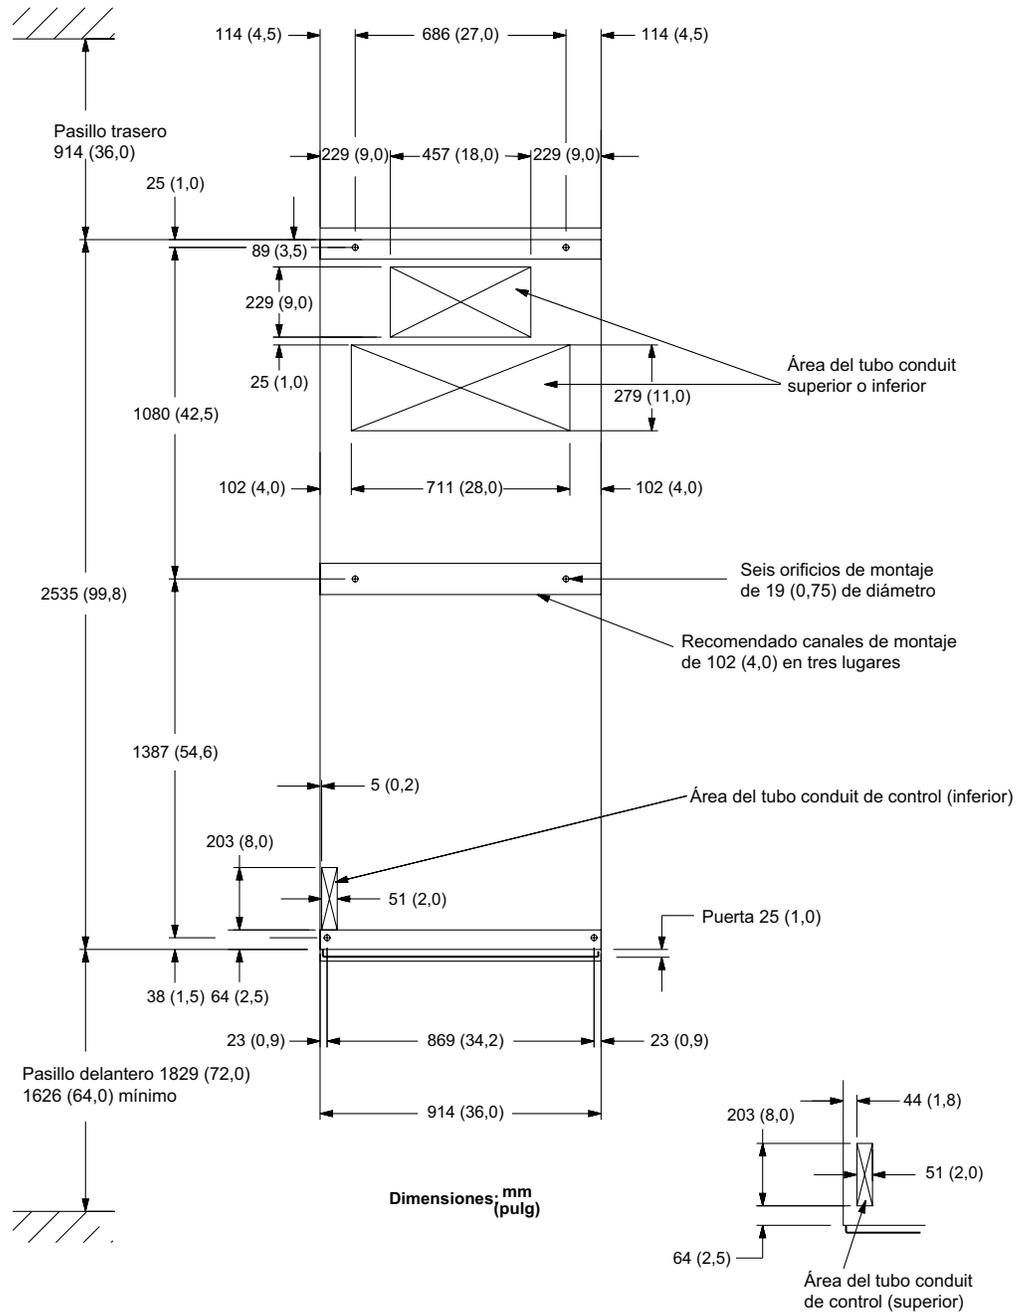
Plan de planta extendido Masterclad para tablero de fuerza de 63 kA
